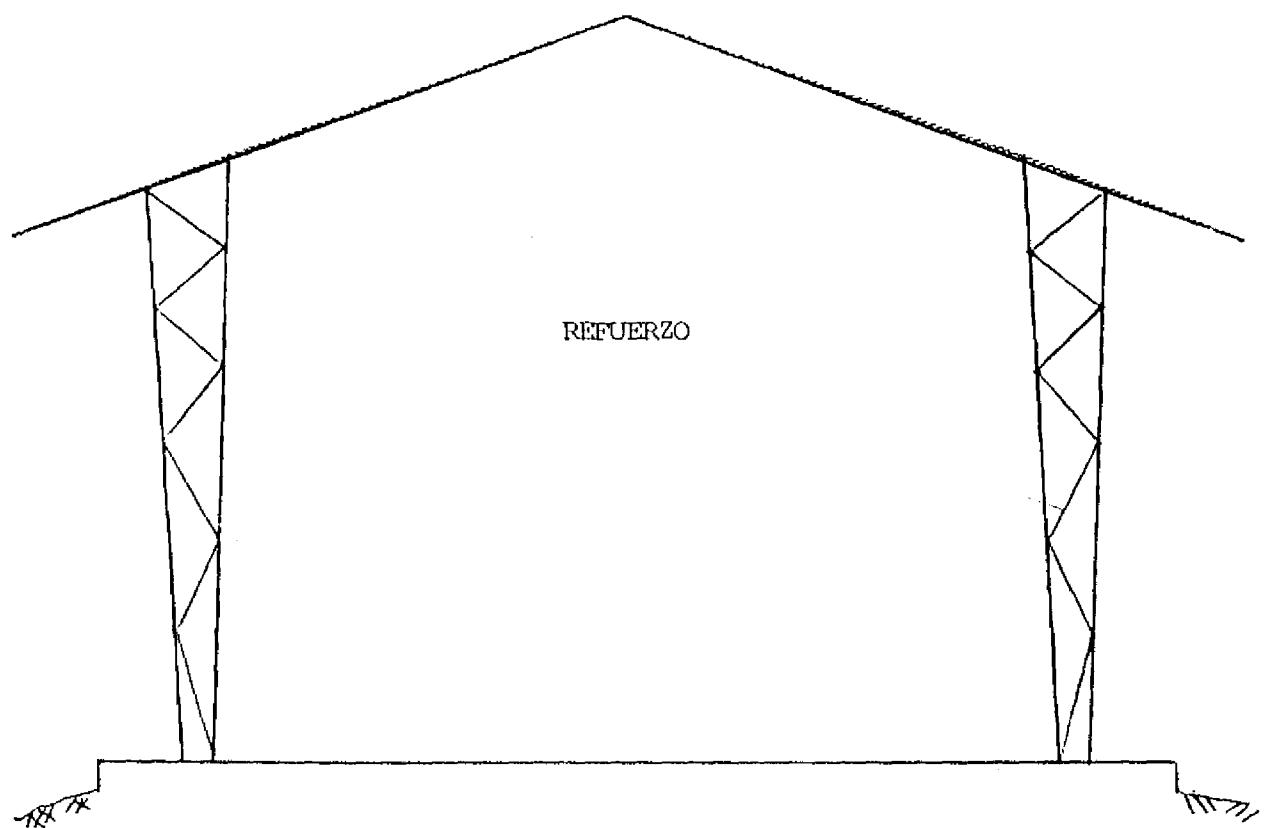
REFUERZO TRANSVERSAL PROPUESTO PARA LAS CAMINERIAS
